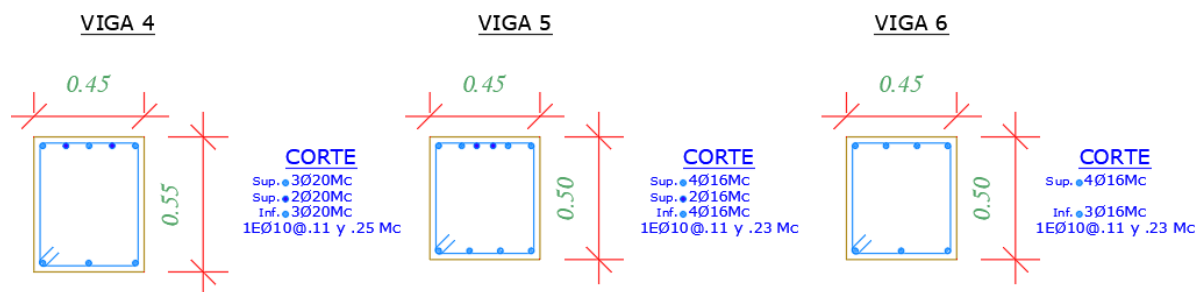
Secciones transversales de las vigas utilizadas en un edificio de 6 pisos
